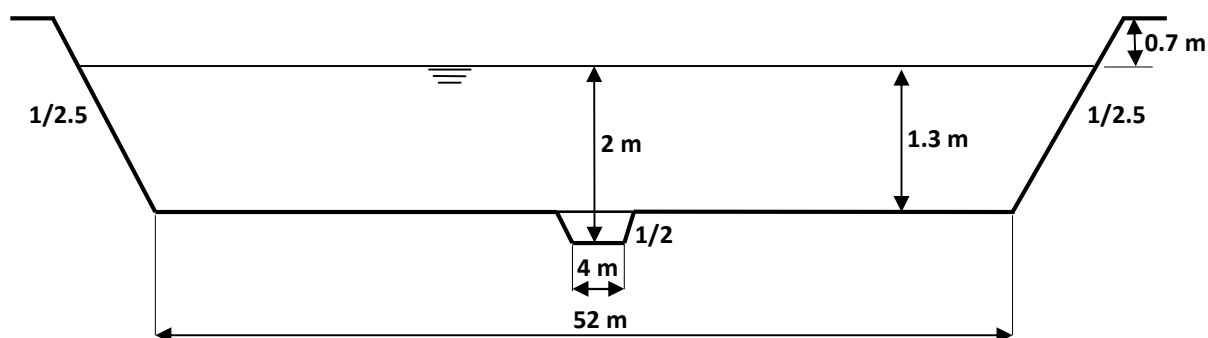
Coupe transversale du premier bassin (bassin de tête)
